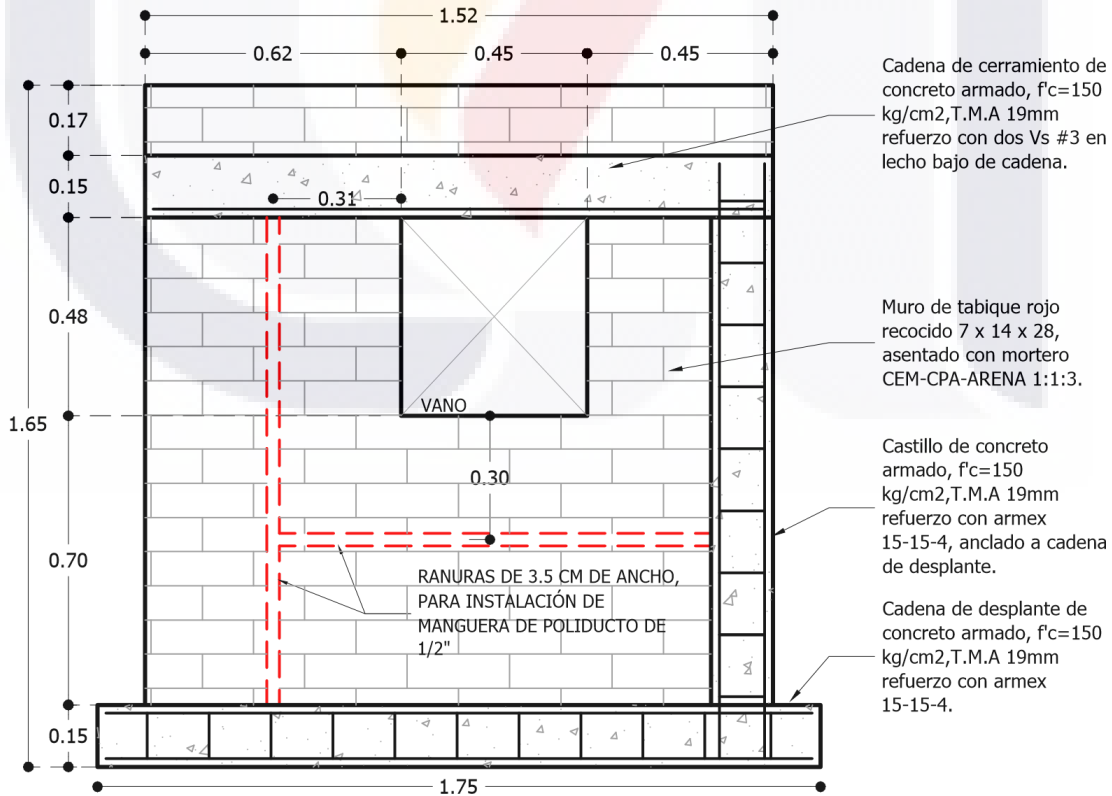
Detalle constructivo de diseño de MTR 2 Cara A
